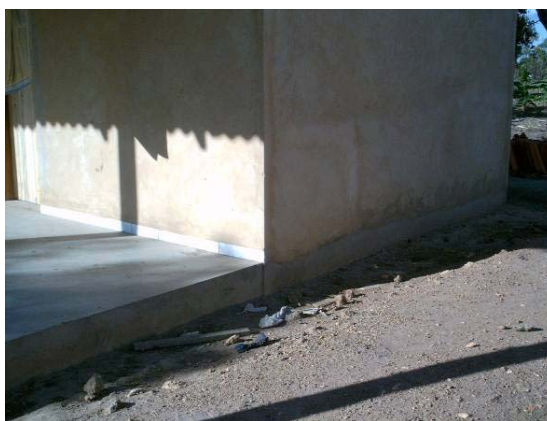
Vista da fundação de pedra que aflora o nível do terreno, com acabamento rebocado
